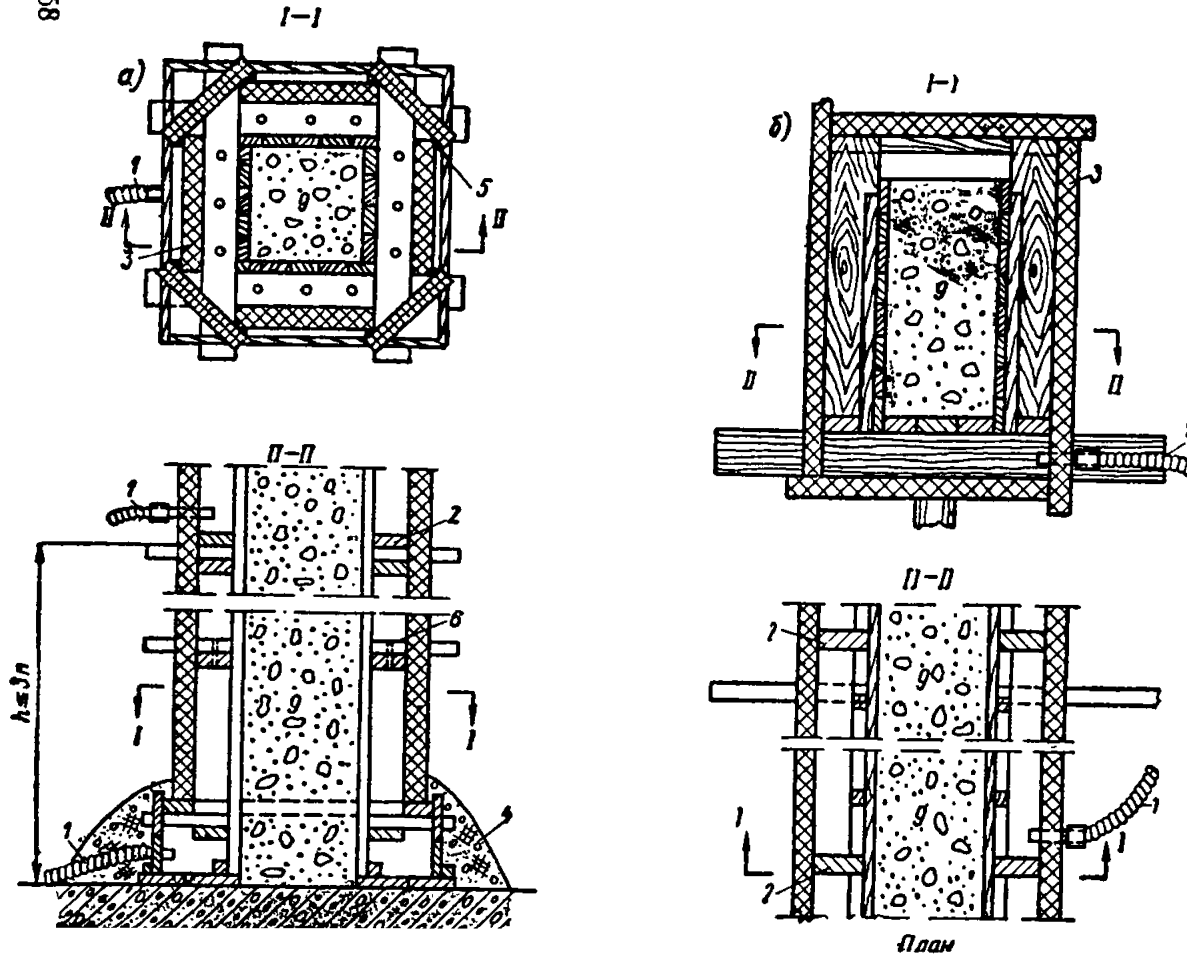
Схемы устройства опалубки при обогреве бетонных и железобетонных конструкций паром или горячим воздухом
